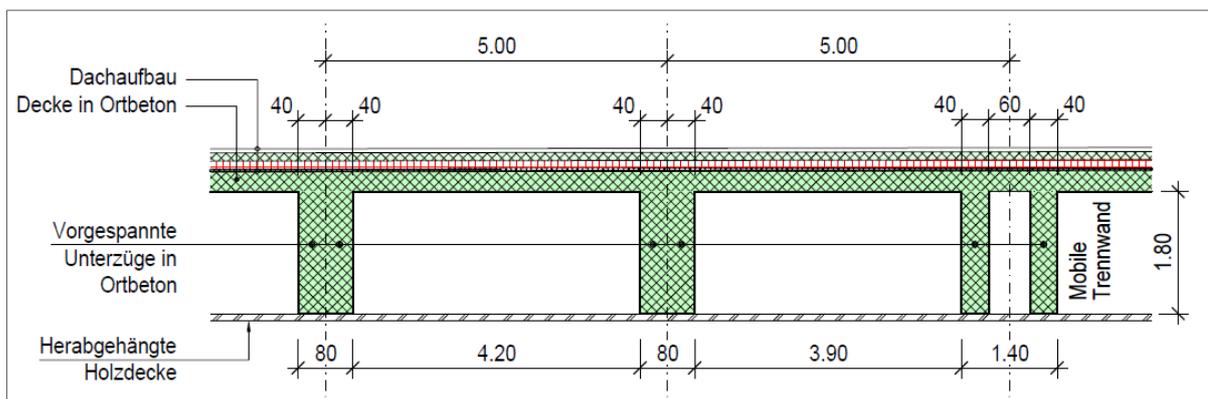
Teilquerschnitt Tragwerk mit Ortbetonunterzügen
